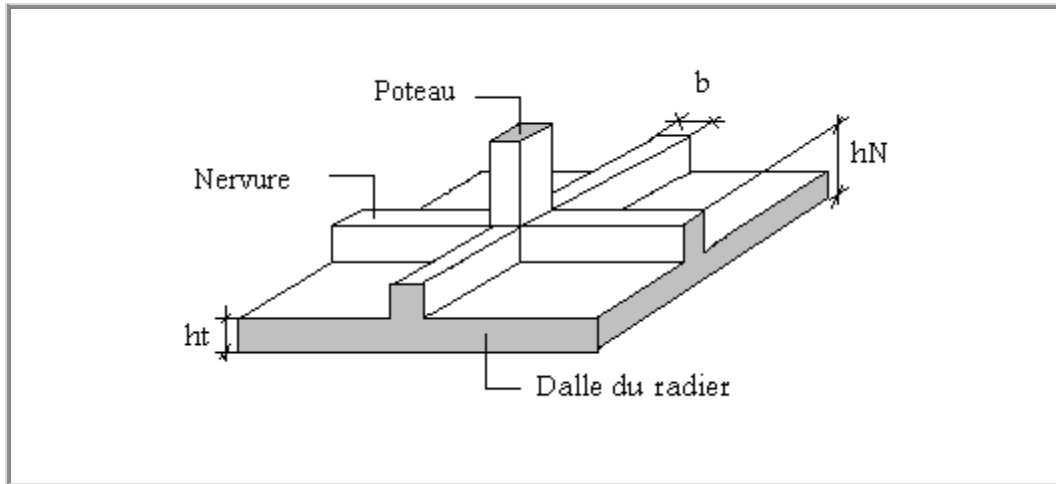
Disposition des nervures par rapport au radier et aux poteaux
